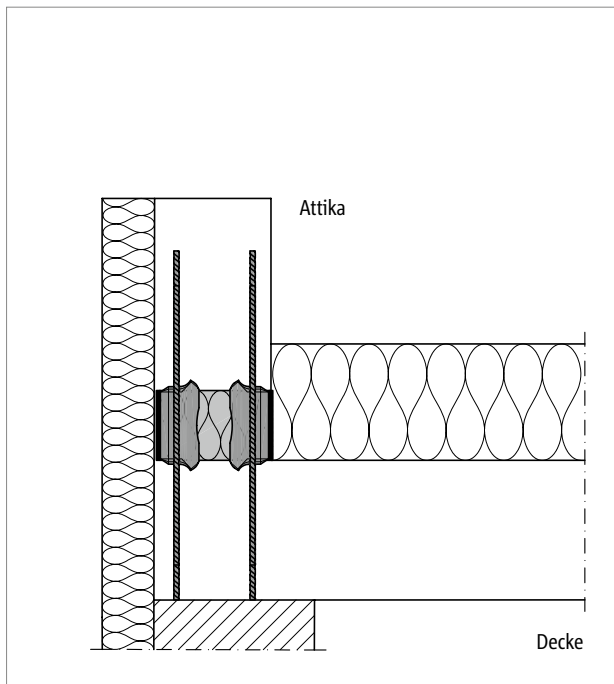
Schöck Isokorb® CXT Typ A: Anschluss einer Attika
